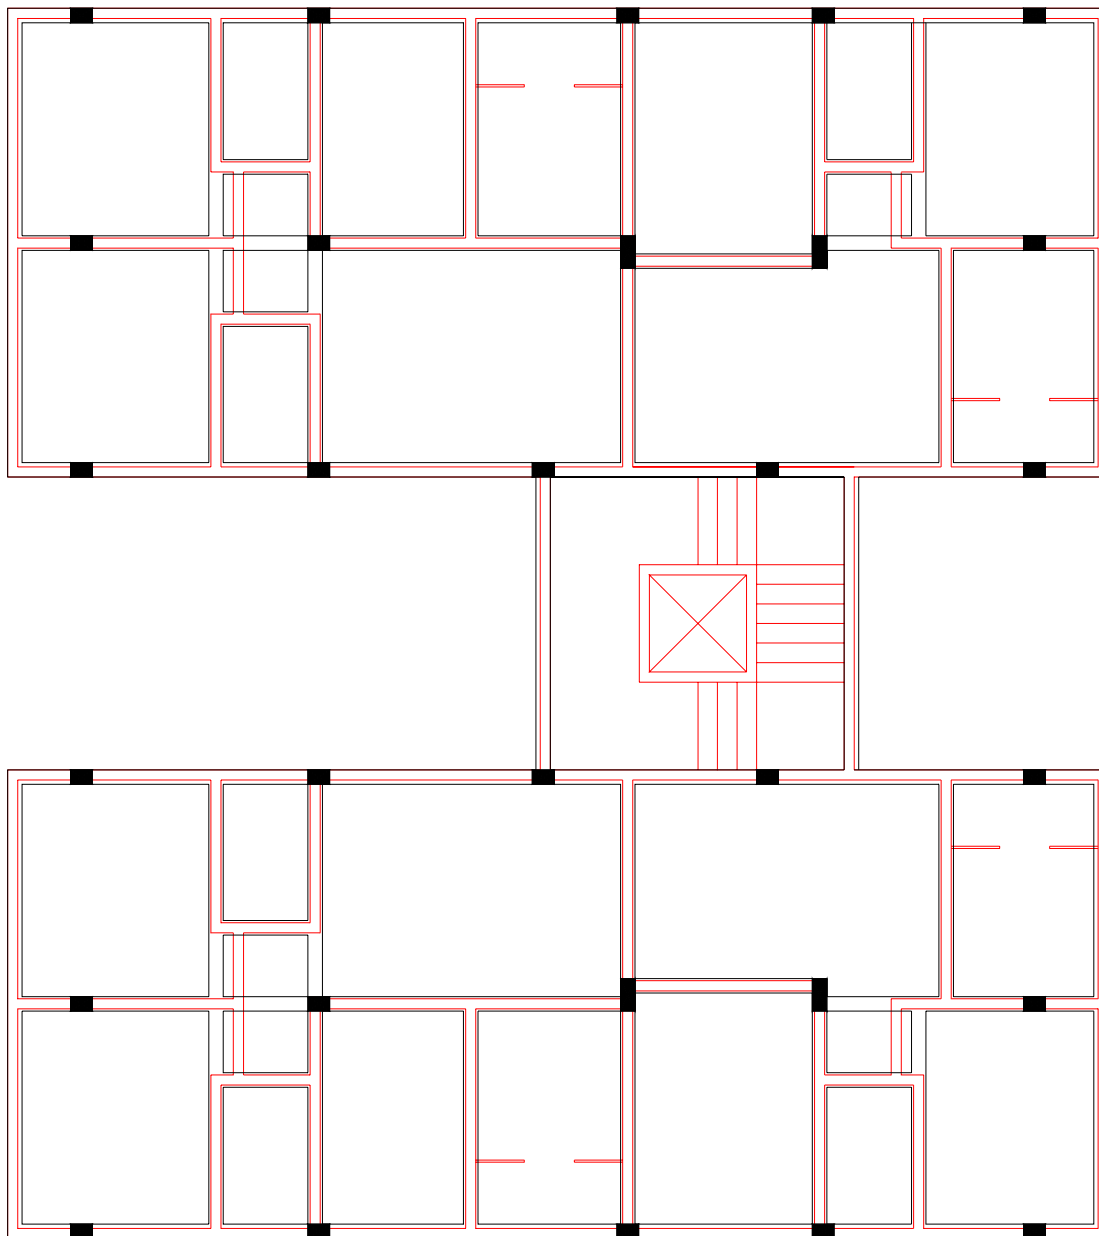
Prédio “A”– Opção 1 – Superposição das alvenarias do pavimento tipo sobre a estrutura
